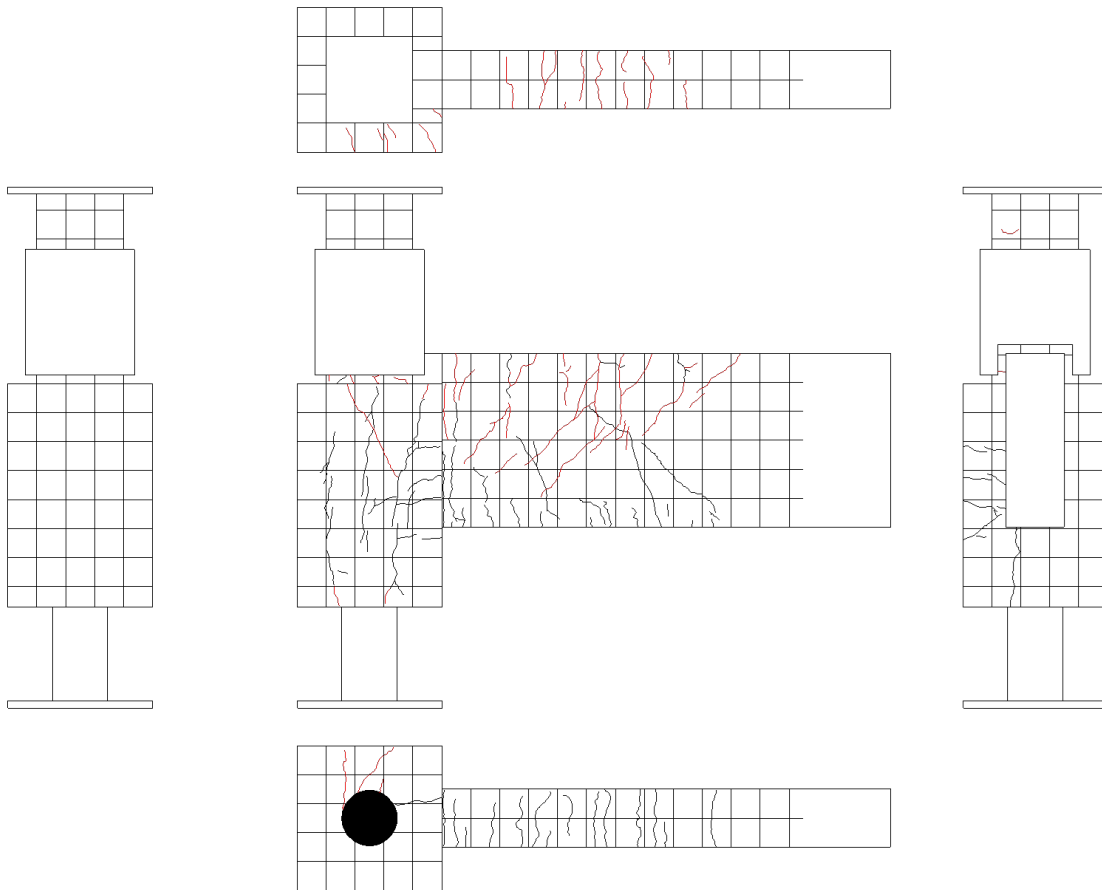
試験体 A-1 ひび割れ状況 (3Cycle)
